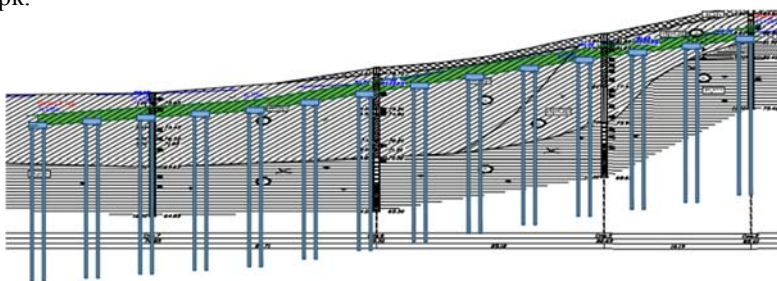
Вертикальная привязка буроинъекционных свай ЭРТ и монолитных железобетонных ростверков по напорный трубопровод $d=1020,0 \text{ мм}$
